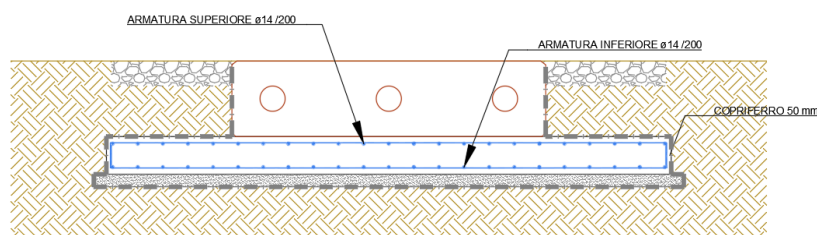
Sezione C della platea di Fondazione della Cabina di Centrale
